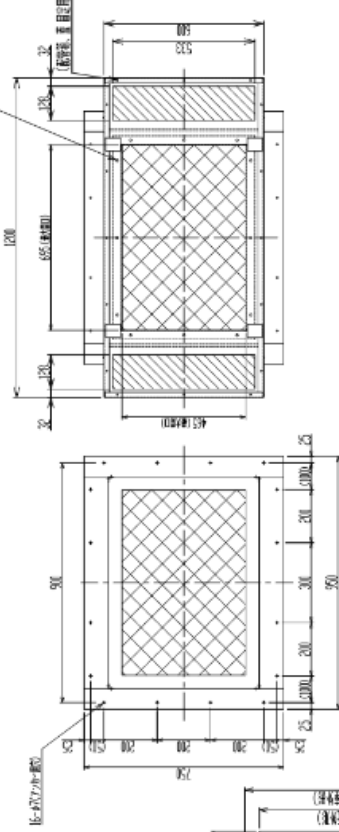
DETAIL B (台座 配管箱 接続ボルト) SCALE 3:4
